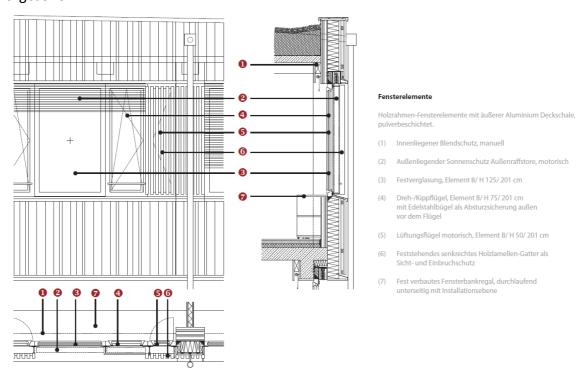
Das integrierte Fassadenkonzept typisches Fensterelement d. Büroräume (IBUS Architekten)
